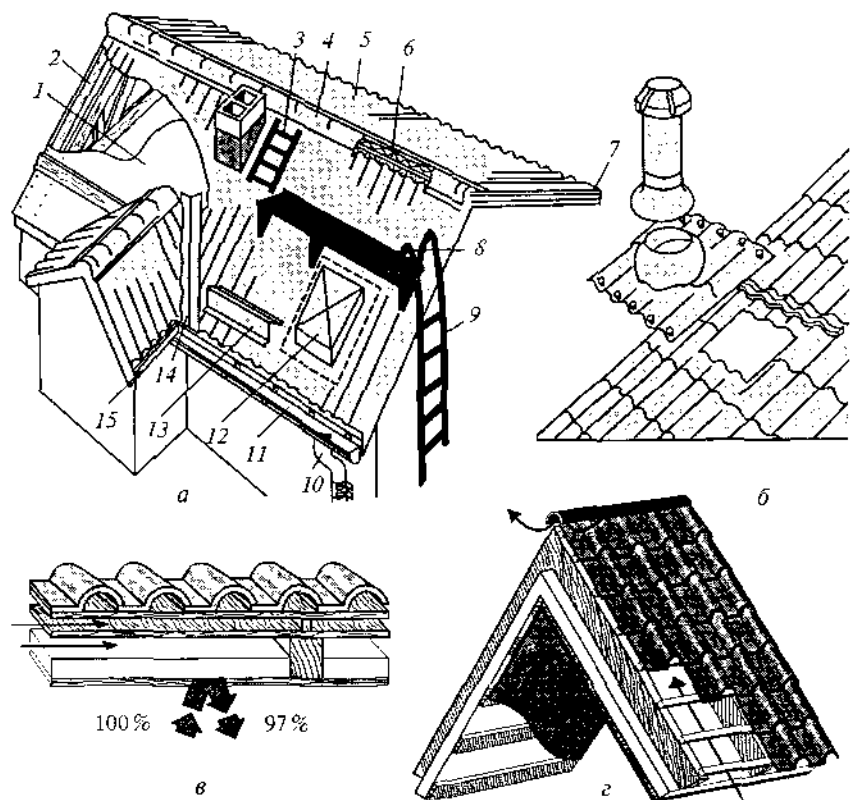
Установка элементов при устройстве кровли из металлочерепицы: *a* — общий вид; *б* — пластмассовая вставка с вентиляционной трубой; *в* — подшивка пенофольгированной изоляции; *г* — обеспечение проветривания кровли; 1 — гидроизоляционная прокладка; 2 — обрешетка; 3 — лестница; 4 — коньковая планка; 5 — кровельный лист; 6 — утеплительные ленты; 7 — торцевая планка; 8 — переходный мостик; 9 — лестница; 10 — водосточная труба; 11 — водосточный желоб; 12 — сквозные листы; 13 — снегосточная планка; 14 — внутренний стык; 15 — карнизная планка
